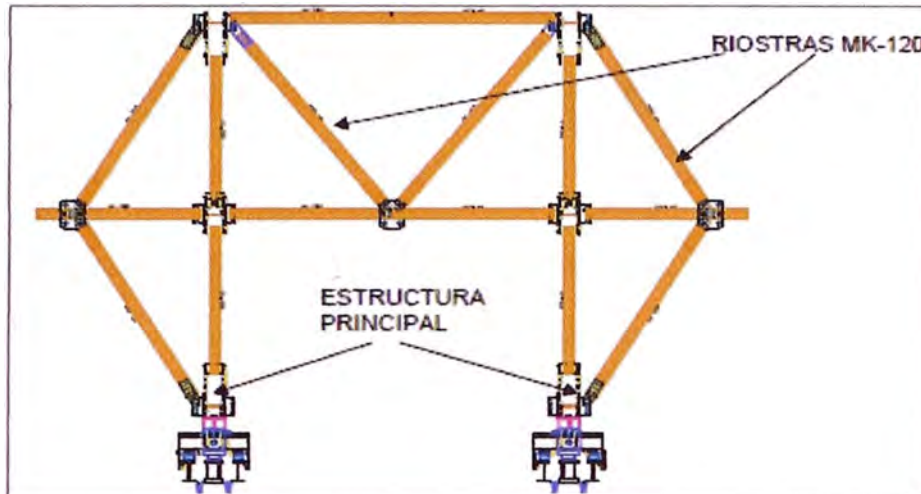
Vista Sección de arriostramiento MK-120 de dos Estructuras Principales.
